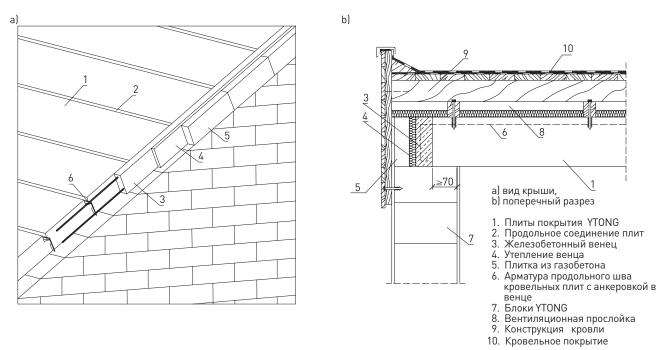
Опирание кровельных плит на торцовую стену заподлицо с краем стены
